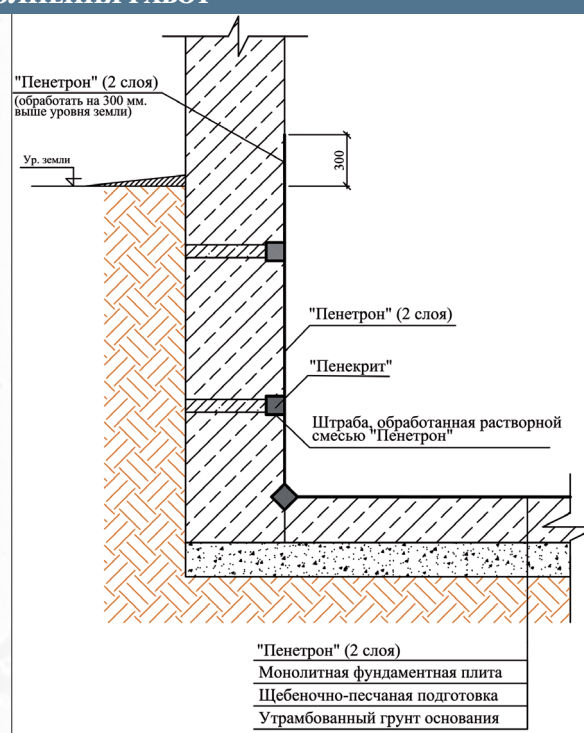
Гидроизоляция швов между фундаментными блоками
